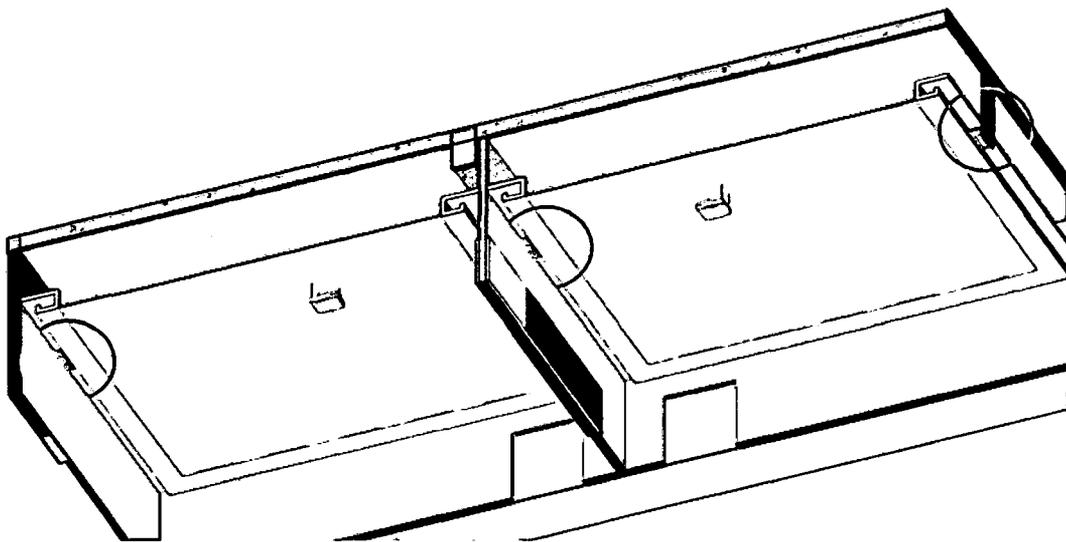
Vigas de concreto interfiriendo con las cenefas del falso cielo raso
